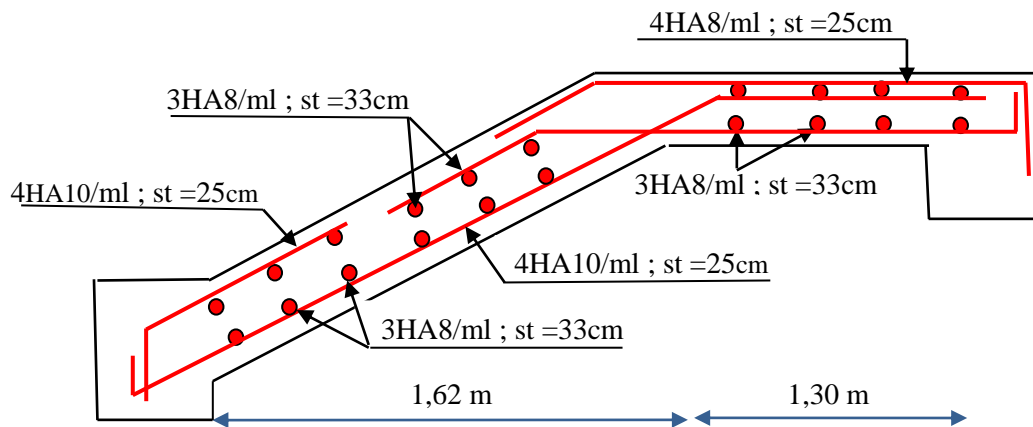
Schéma de ferrailage de l'escalier droit des volées 1 et 3
